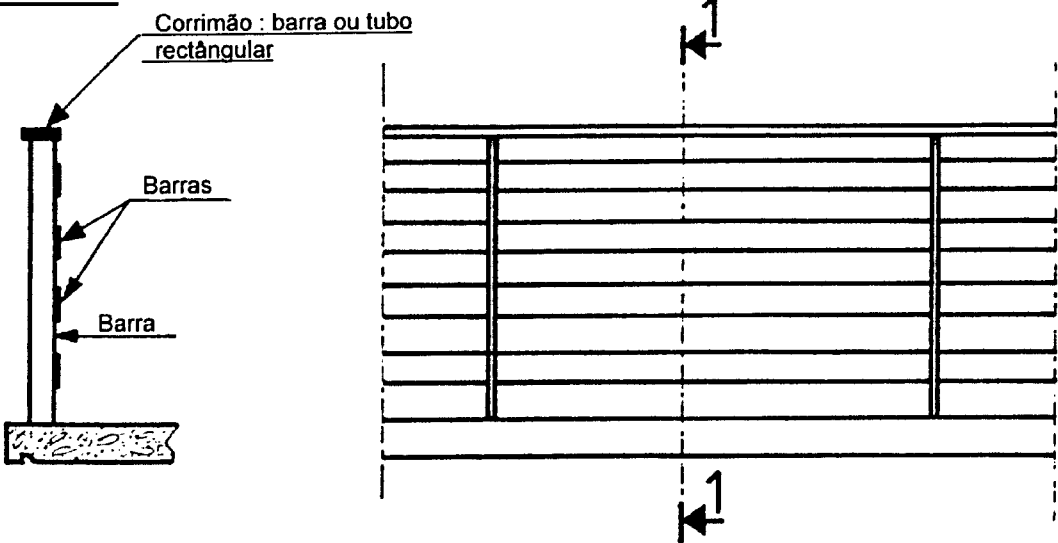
GUARDA-CORPOS COM BARRAS HORIZONTAIS
